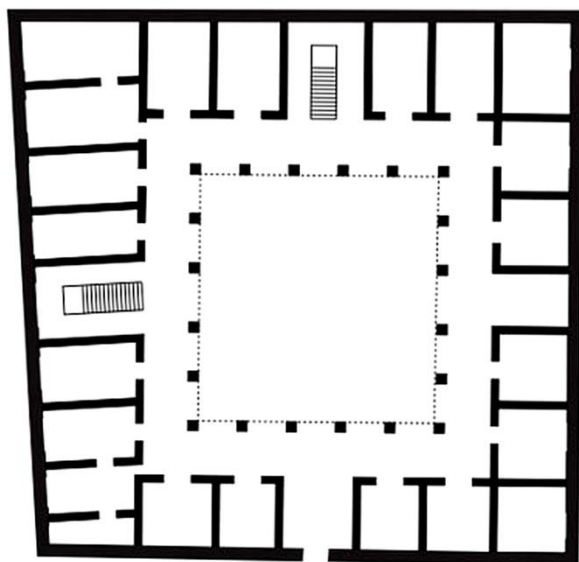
Vue en plan du khan Fakhry Bey, sur trois niveaux (R+2). ©Yasmine El-Chami.
